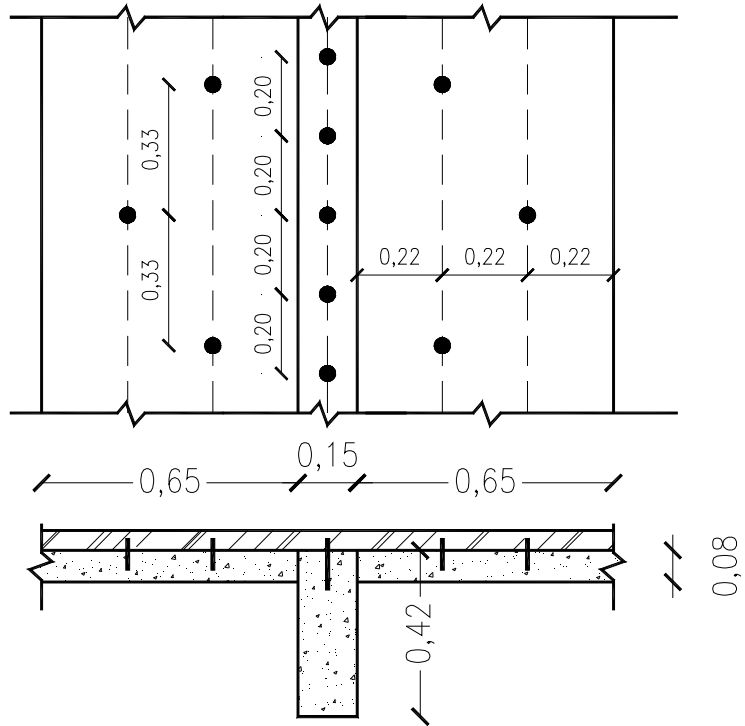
Refuerzo para esfuerzos razantes en vigas estructurales
